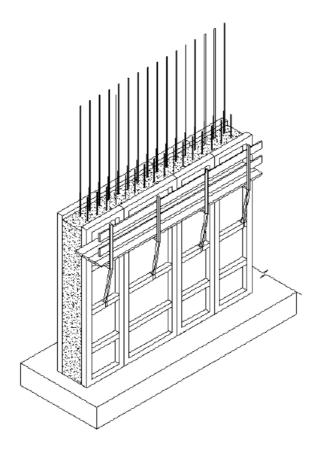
Армирование второго (вышележащего) яруса подпорной стены
